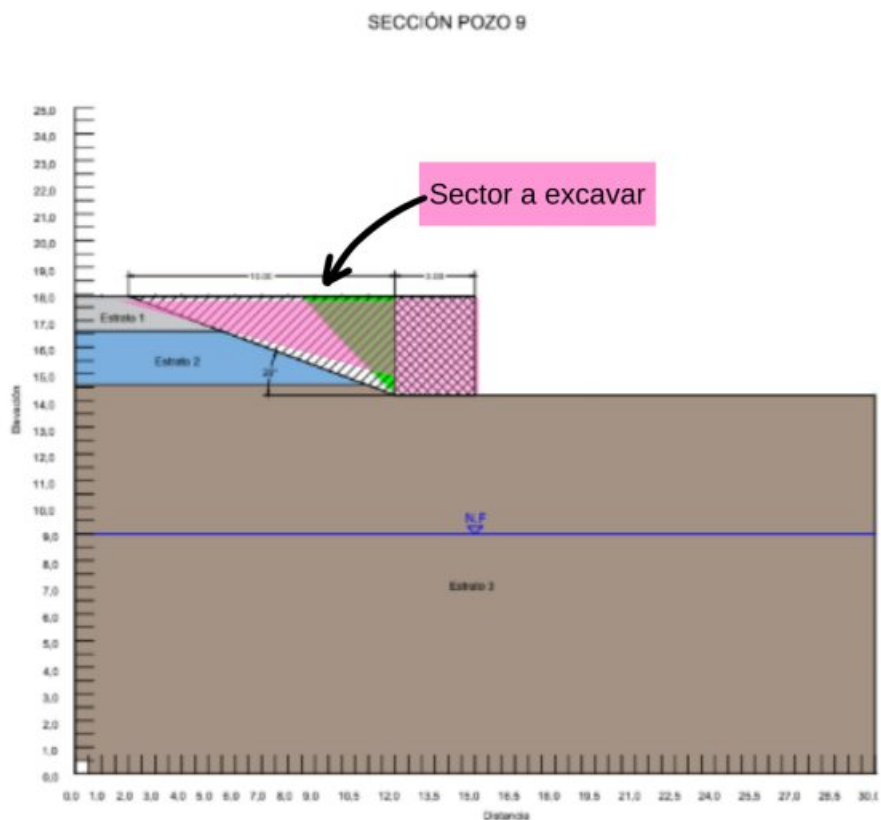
Sección a excavar en pozo 9. Fuente: Elaboración propia.
